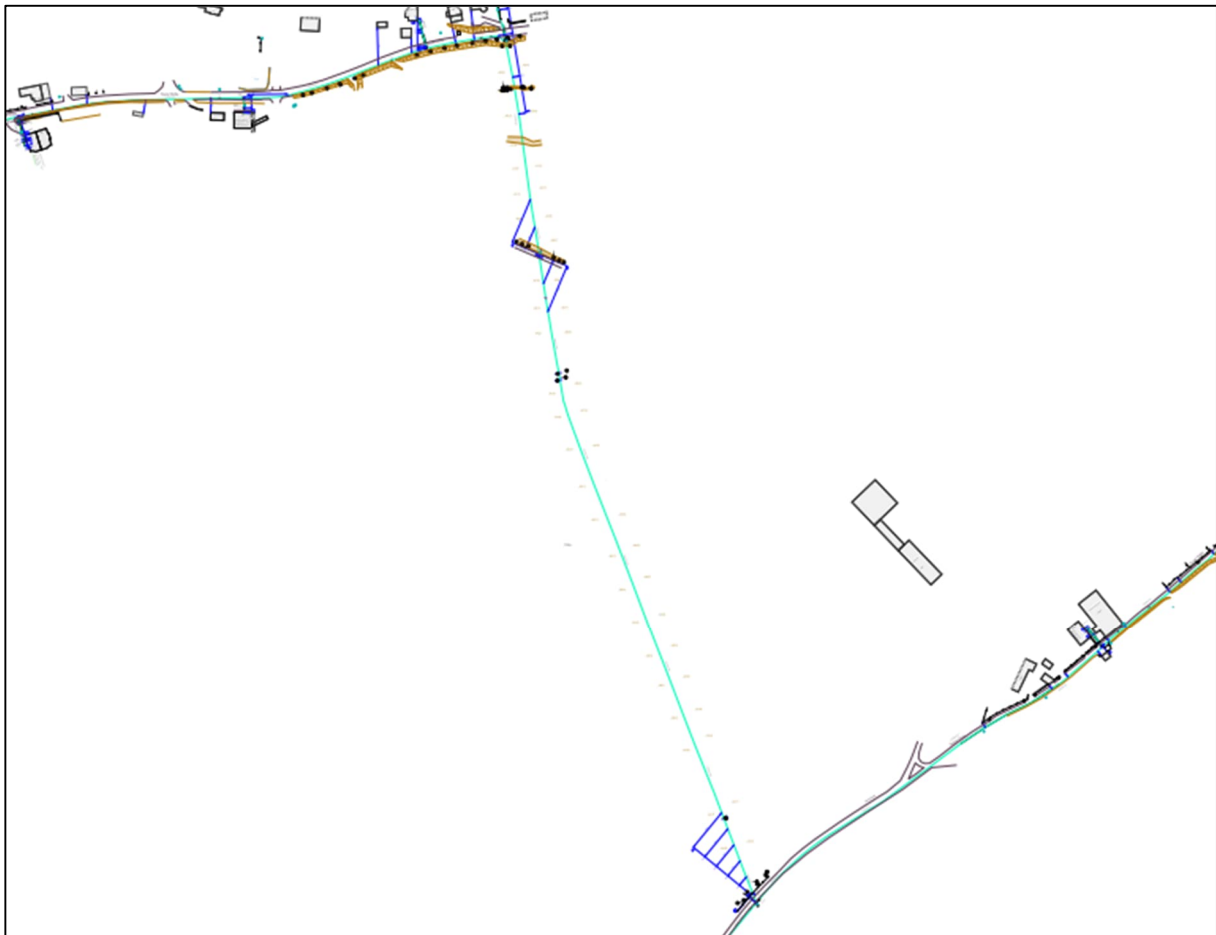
Lageplan inetz zum Leitungsbestand ⁹
